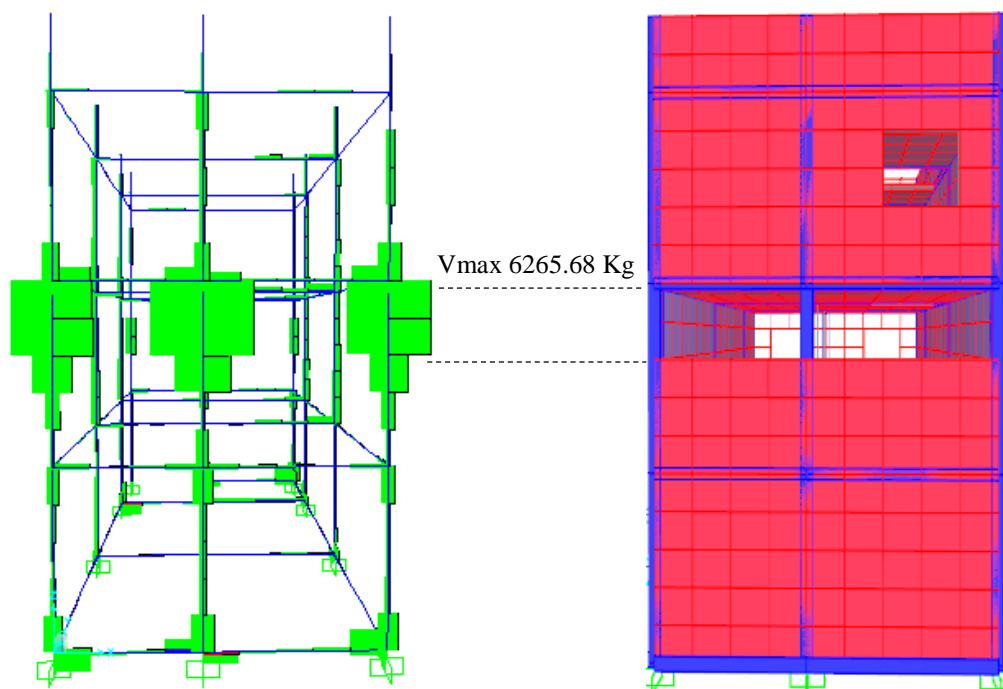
Diagramas de corte en fachada con Columna Corta. Vivienda #2.
